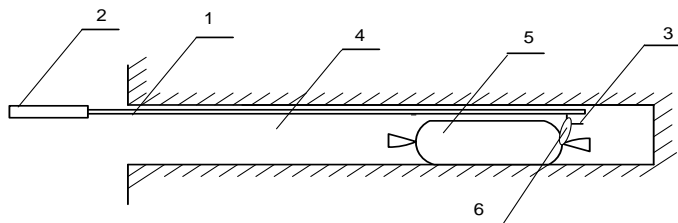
Схема зарядки шпура: 1 – штанга; 2 – рукоятка; 3- вилка; 4 - забой шпура; 5 - унитарный патрон; 6 - петля
